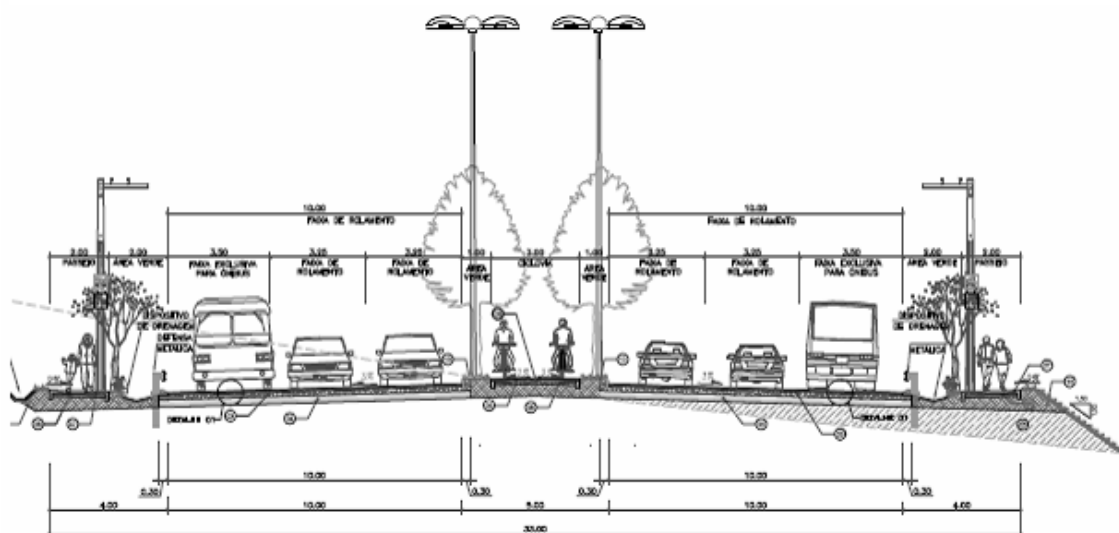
19 - Perfil transversal da via principal do Trecho 2
